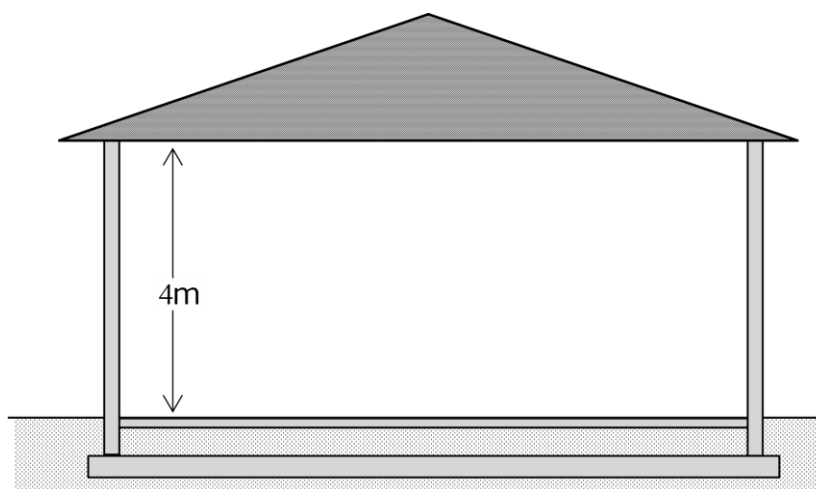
exemple d'un bâtiment de type 5(c)m
